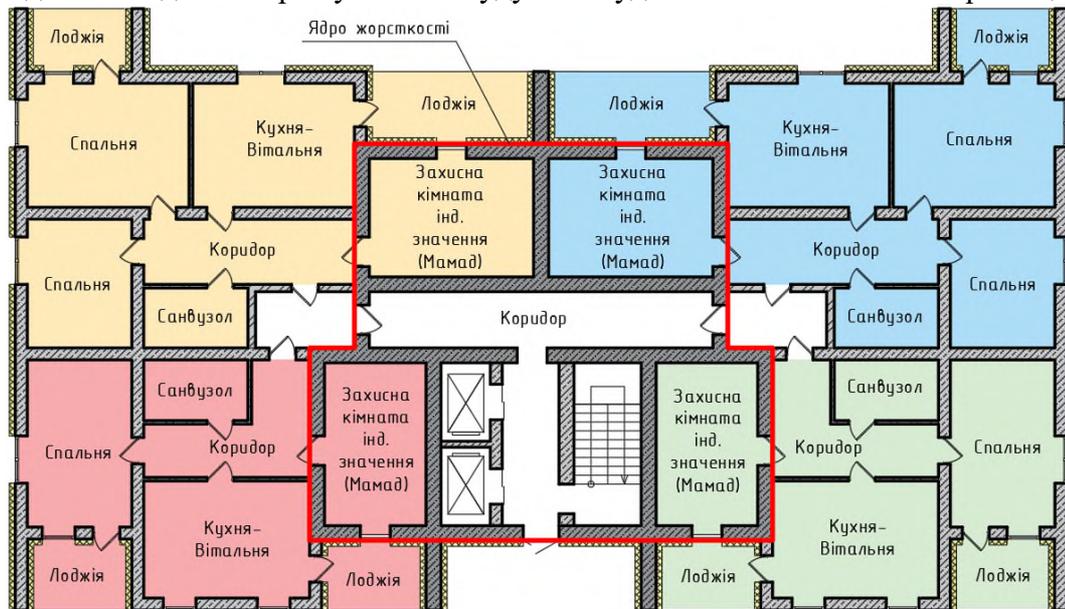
Запропоноване конструктивно-планувальне рішення з улаштуванням захисних споруд у багатоповерховій будівлі.
